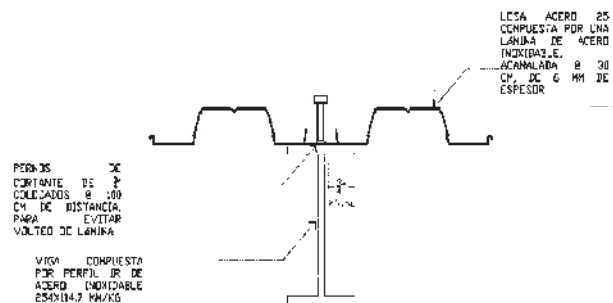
Detalle colocación de conectores de cortante. Elaboración propia,
